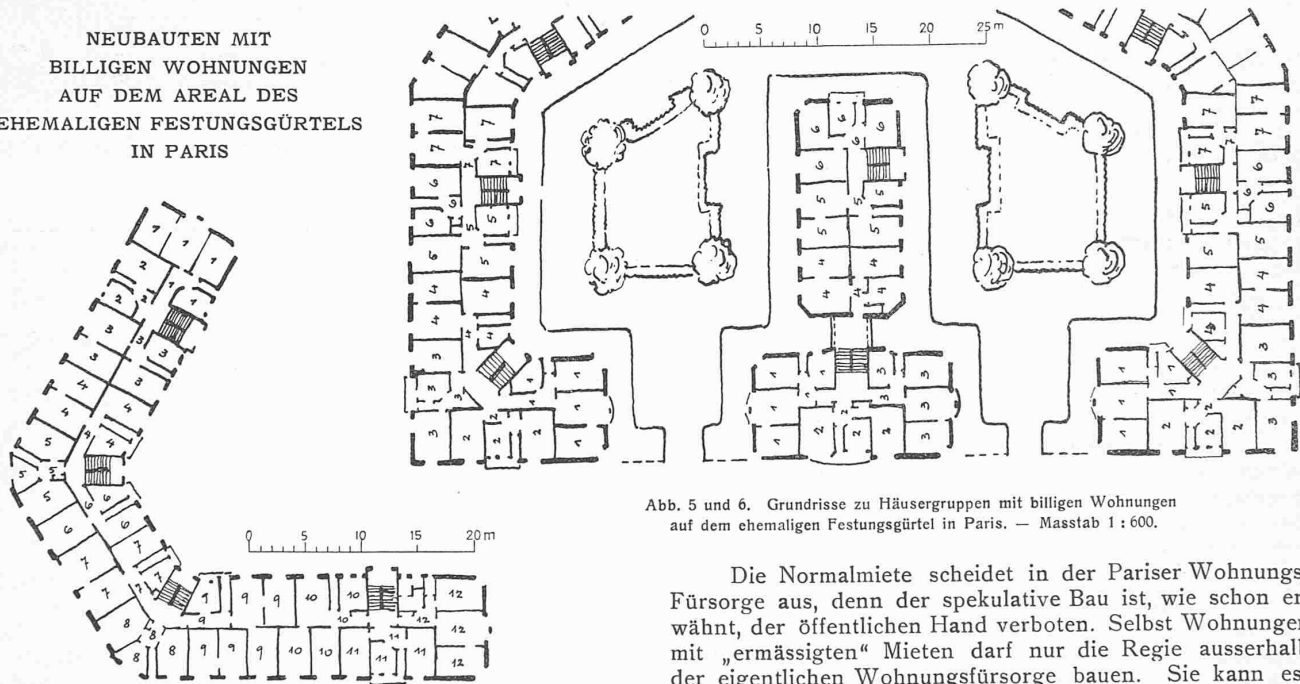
und 6. Grundrisse zu Häusergruppen mit billigen Wohnungen auf dem ehemaligen Festungsgürtel in Paris. — Masstab 1:600.
